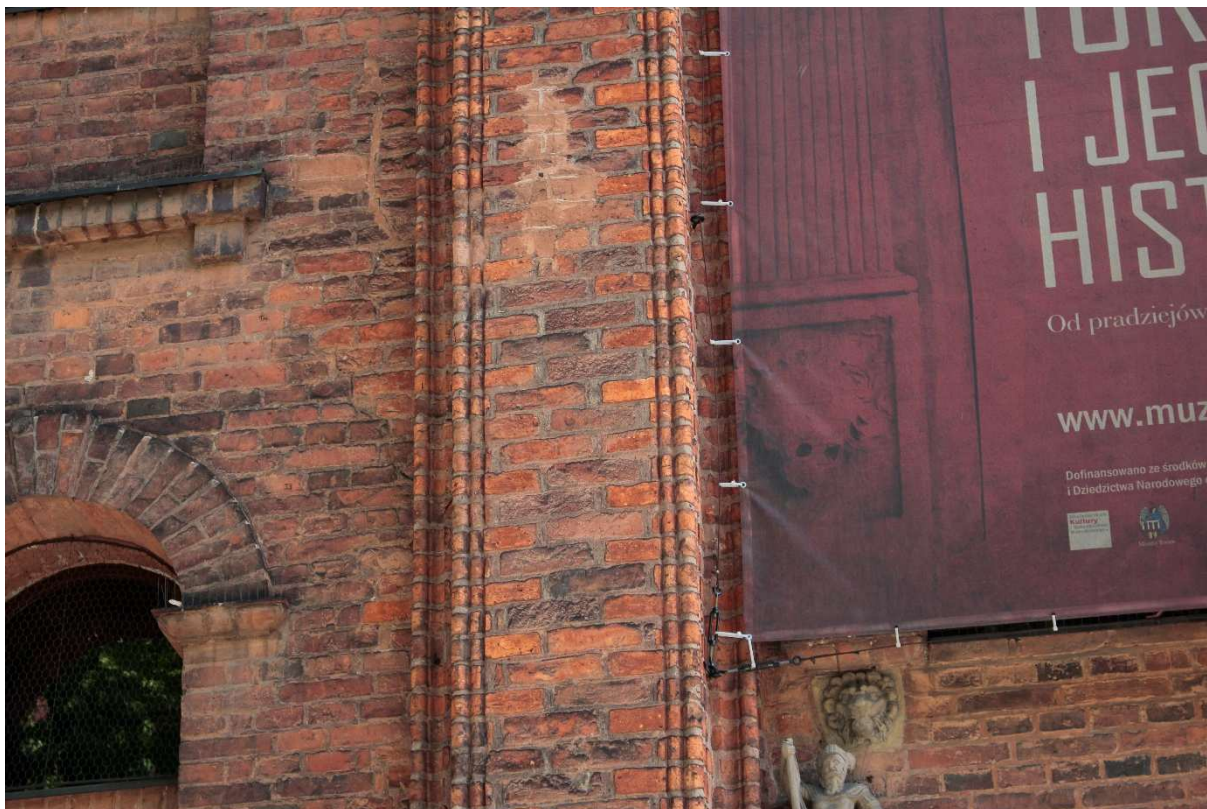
Dom Eskenów, Łazienna 16. Stan zachowania elewacji. Lokalnie obserwuje się spękania wątku ceglanego przebiegające wzdłuż spoin. Na zdjęciu widoczne także rekonstrukcje płytek parapetu.
